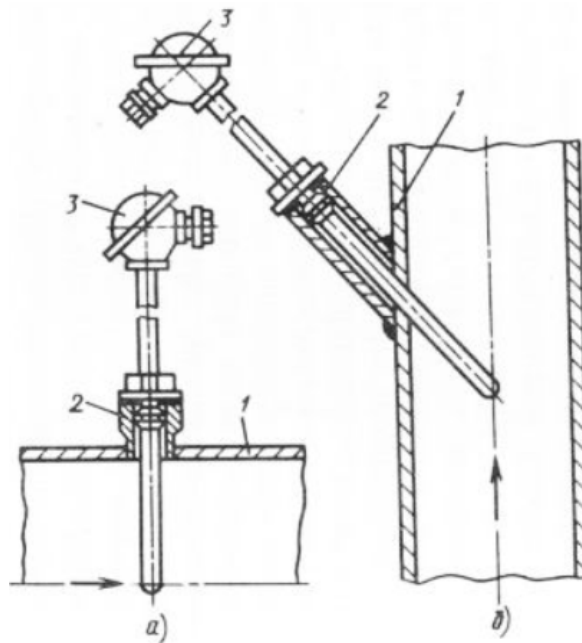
Монтаж термоперетворювача опору на трубопроводах:
